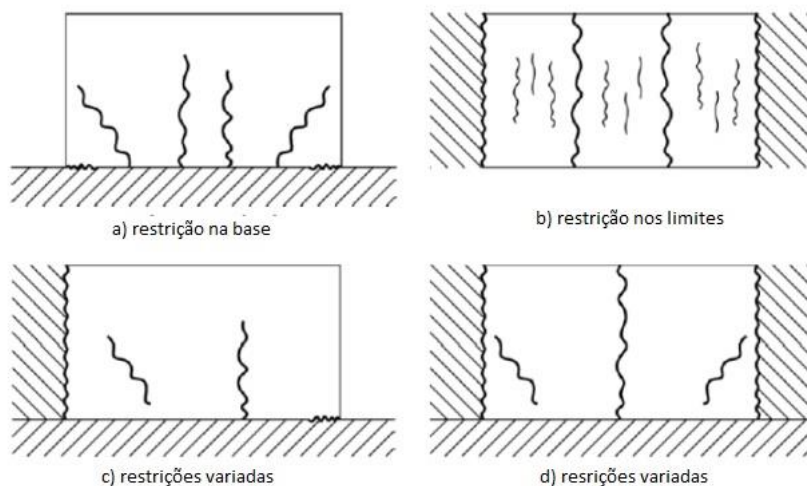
Fissuras por retração (Rodrigues, 2019)
